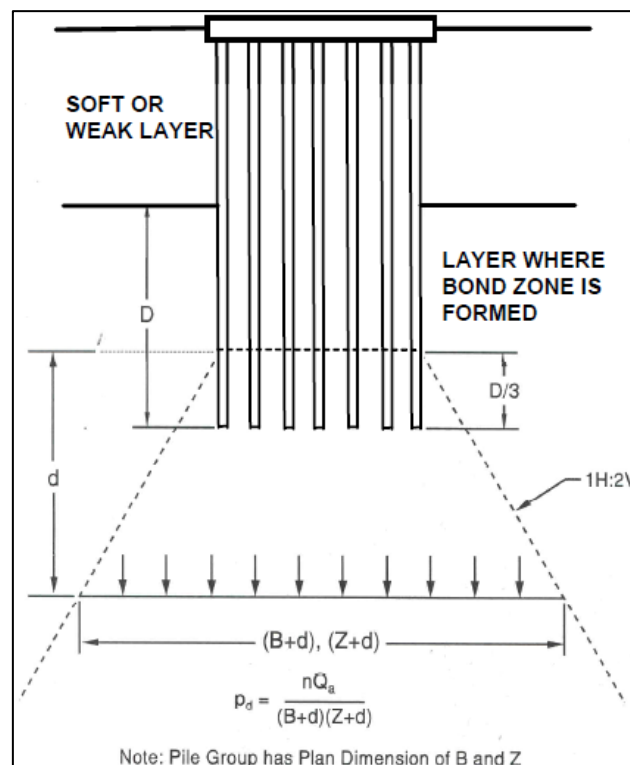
Zapata equivalente suelos perfil con arcilla. Equivalent Footing Concept for Firm Soil Underlying Soft Soil Layer. FHWA NHI-05-039 Chapter 5 – Design for Structure Foundations, December 2005
